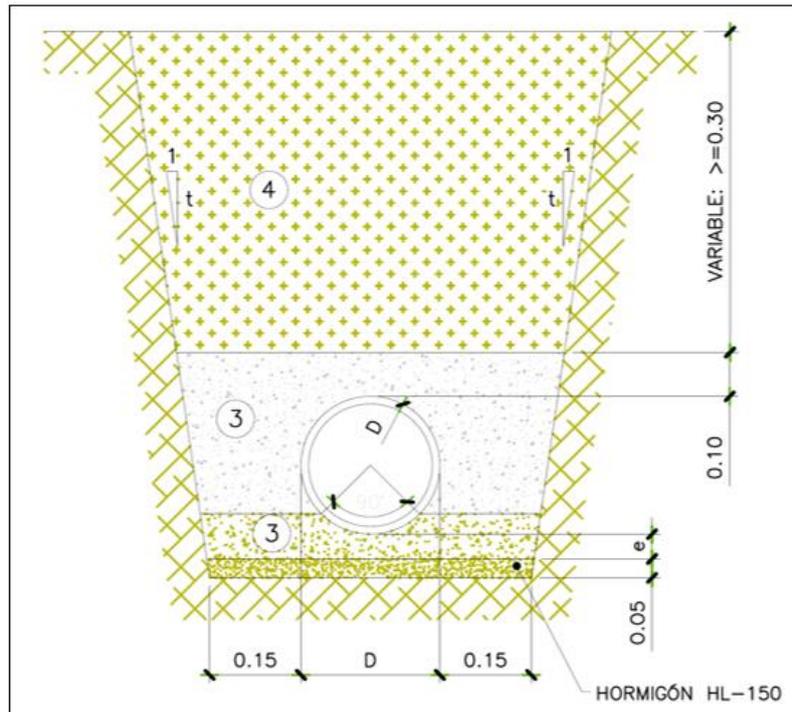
Tubo de PVC en sección reforzada con hormigón en lecho de asiento.
